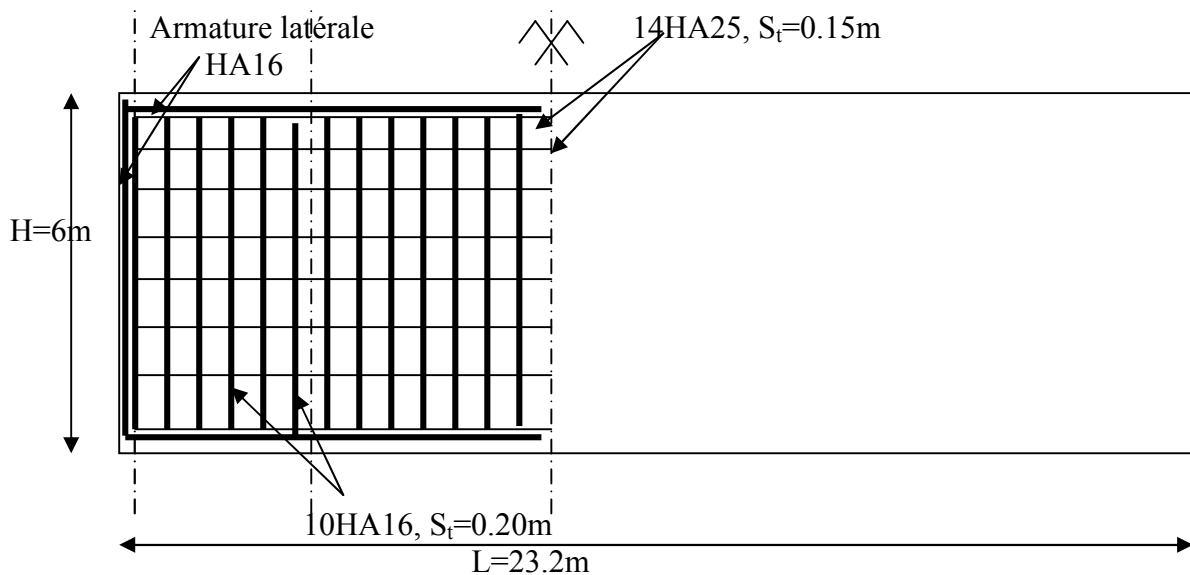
Ferrailage de la semelle (nappe supérieure).
